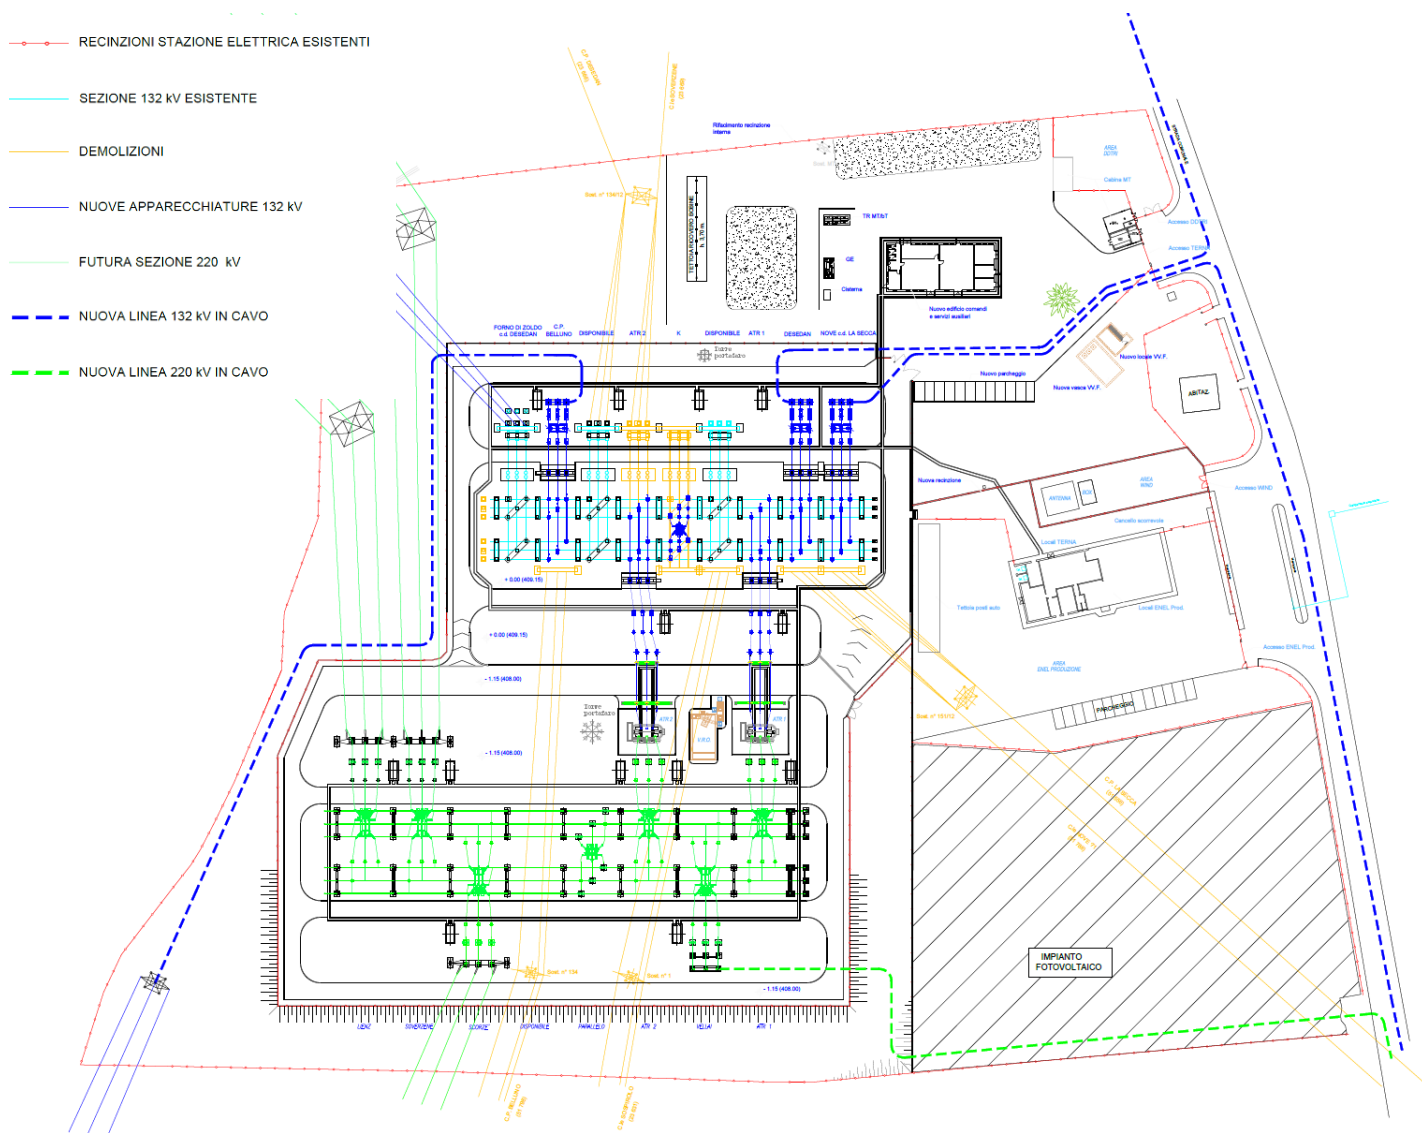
Planimetria elettromeccanica - Stato di Progetto
